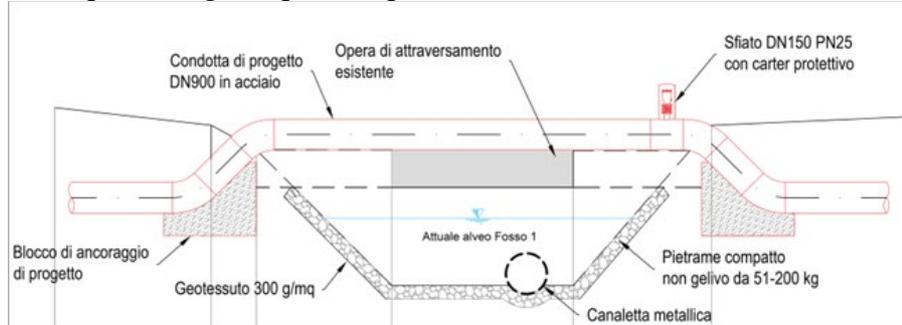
Sezione longitudinale attraversamento aereo autoportante di progetto sul Fosso Verde.
